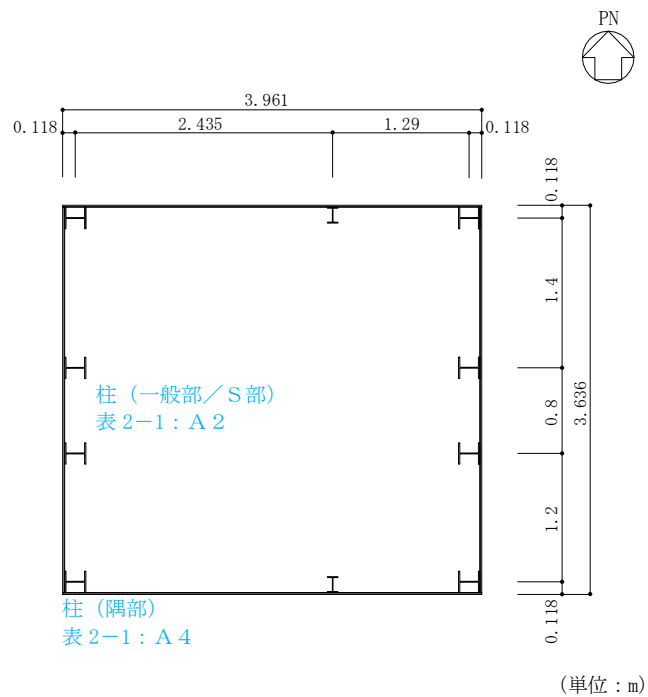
(1) ディーゼル燃料移送ポンプエリア防護対策設備 (北側) の概略平面図 (EL 8.7m)
